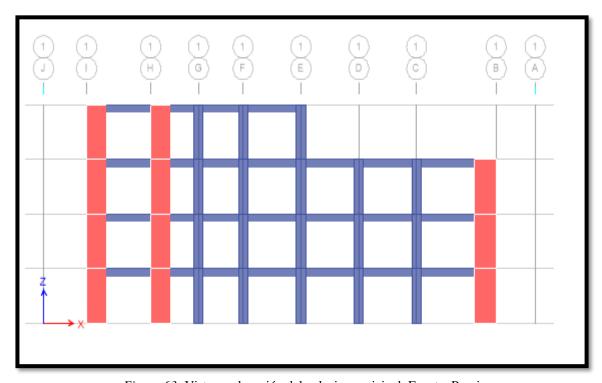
Vista en elevación del palacio municipal. Fuente: Propia
